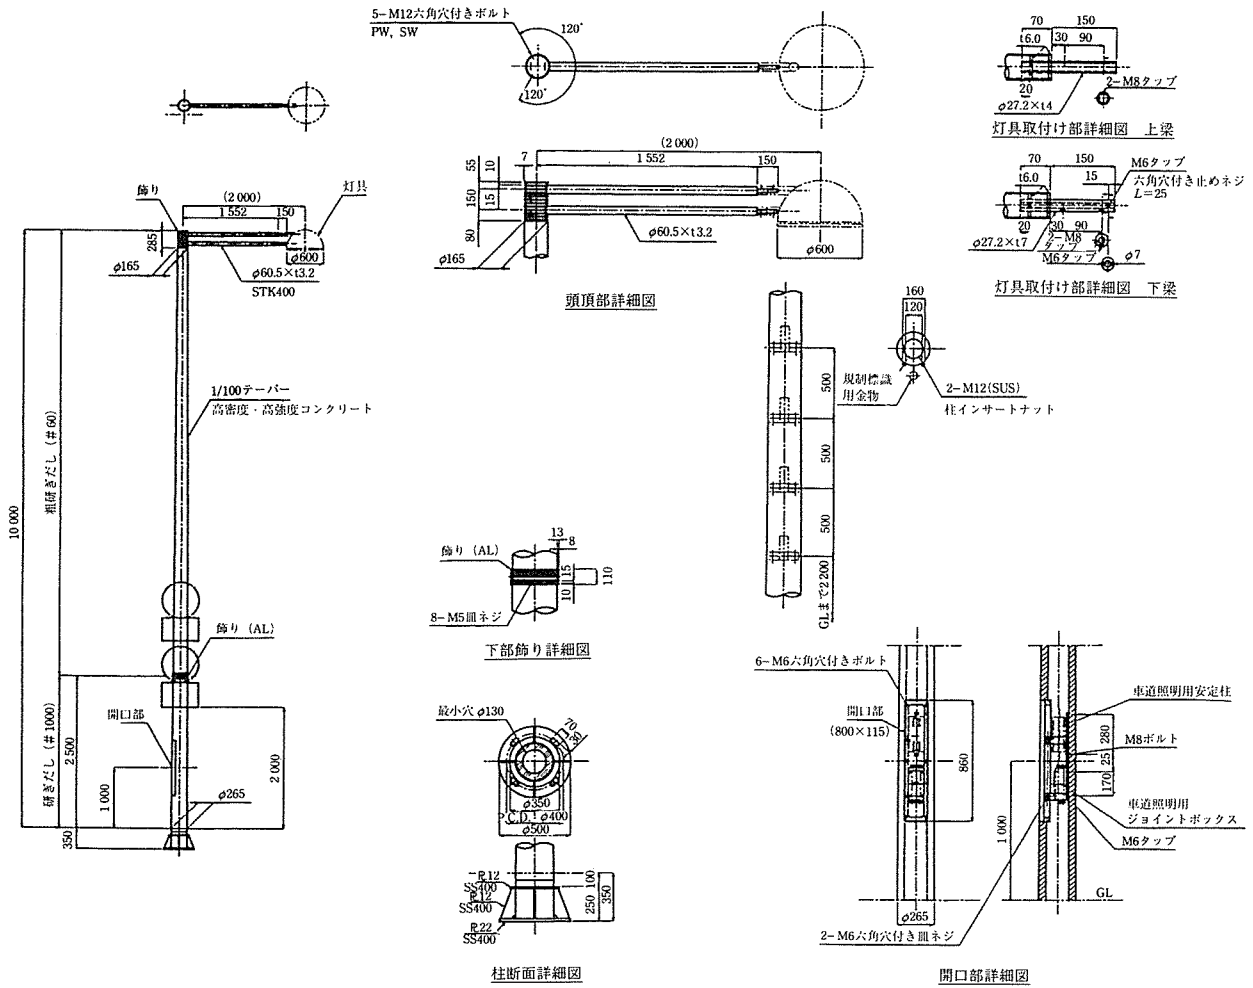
東京都臨海副都心道路 10 m ポール標準型一般図
